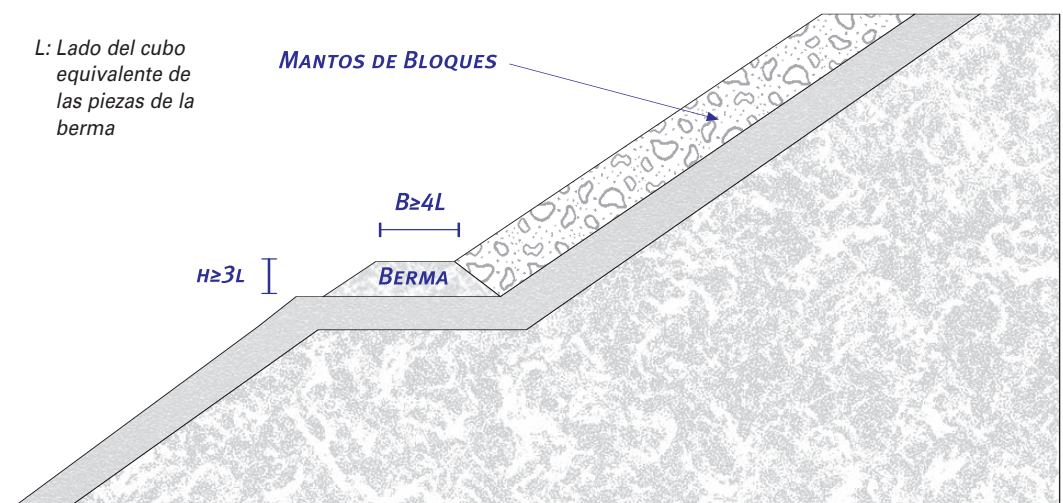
Sección de berma recomendada de apoyo de bloques a medio talud.
